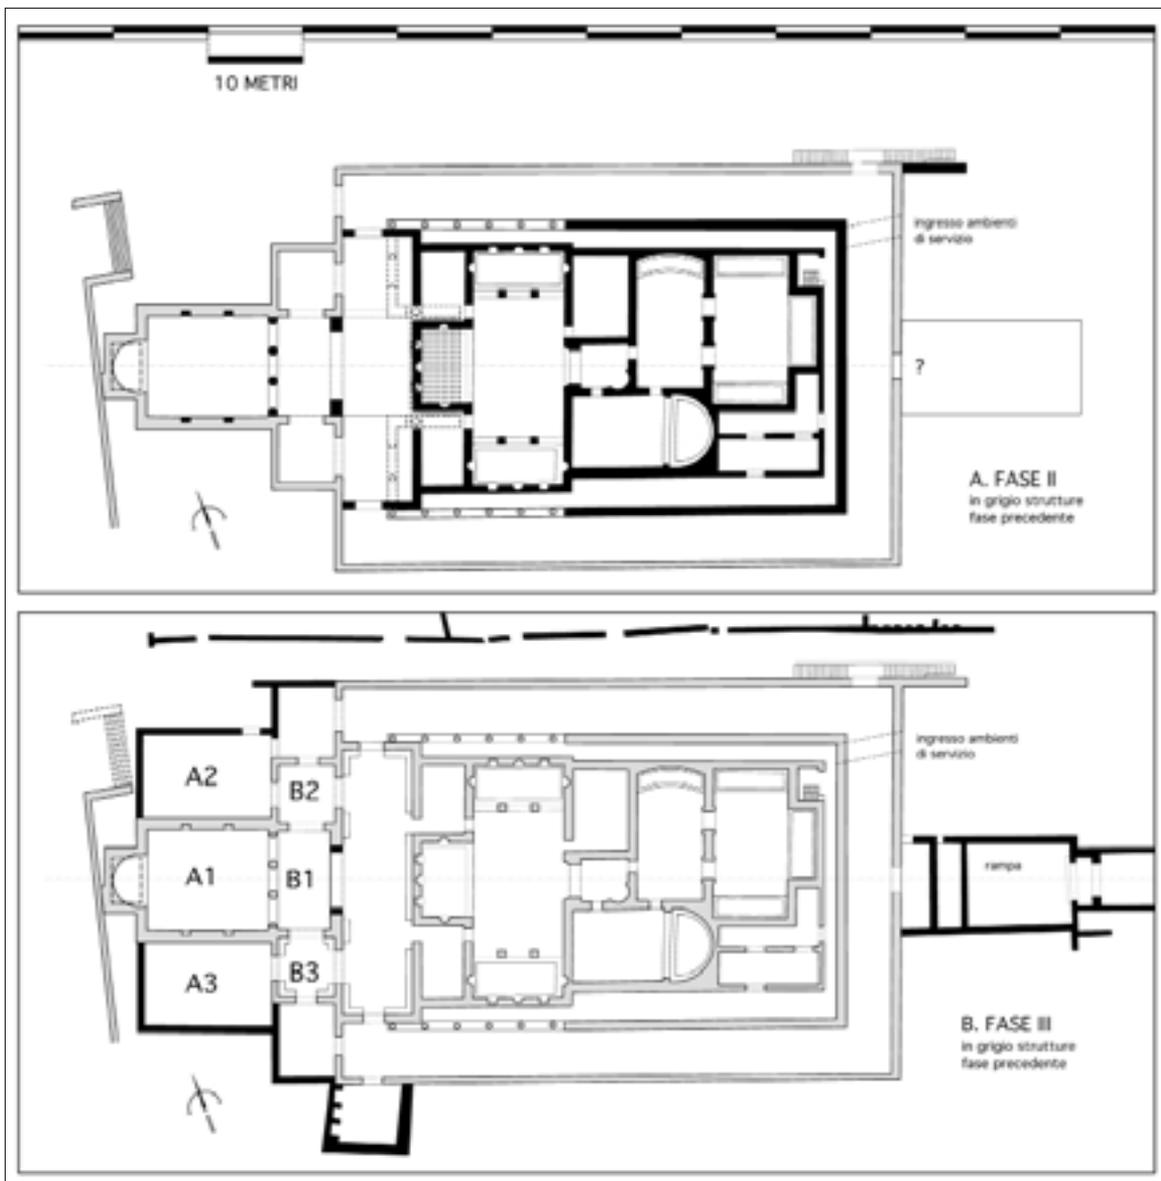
A) Pianta della fase di II sec. d.C.; B) fase di III sec. d.C. (disegno dell'autore rielaborato da AUPERT 1994, figg. 2-3).
